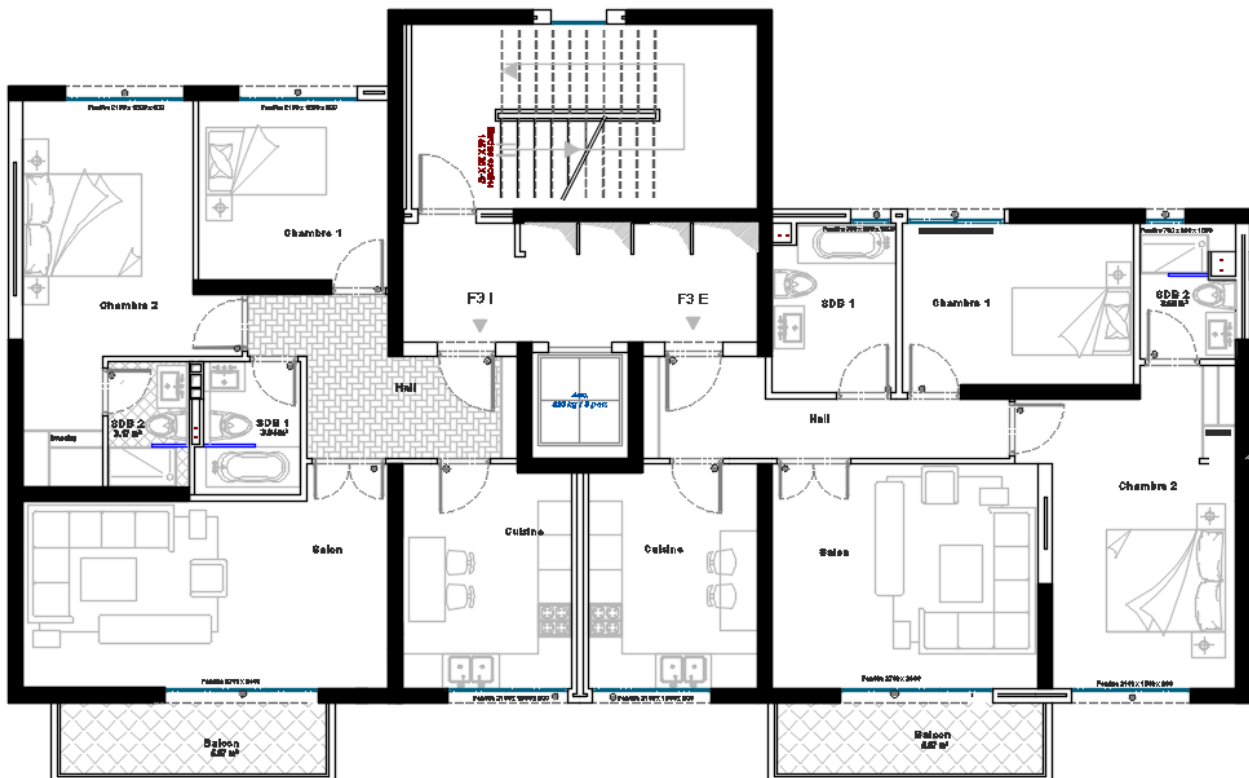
Plan d'architecture d'un étage courant selon le 2<sup>ème</sup> système constructif
